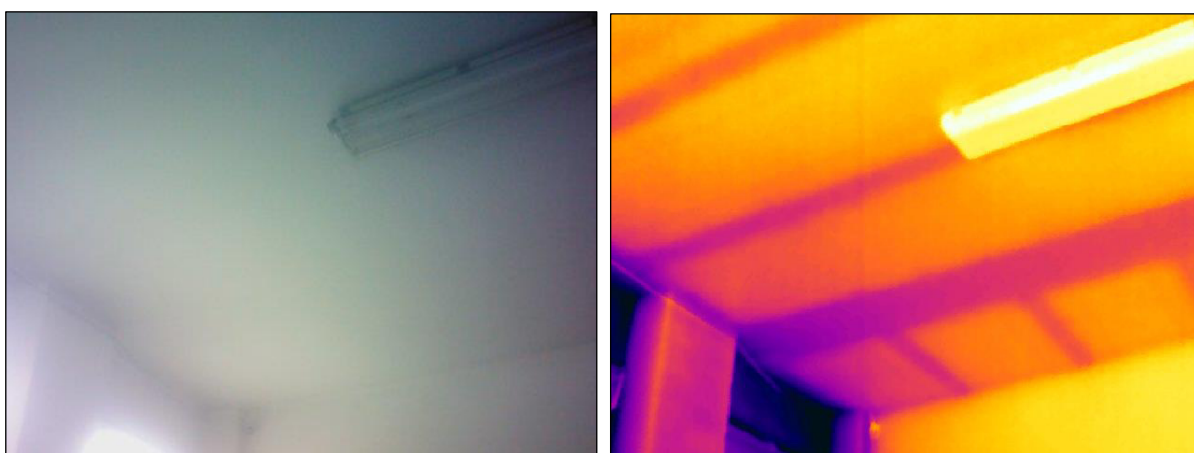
Nell'Ambulatorio Medico al secondo piano è stato individuato il tracciato caratteristico di una trave confinata nello spessore dell'impalcato.
